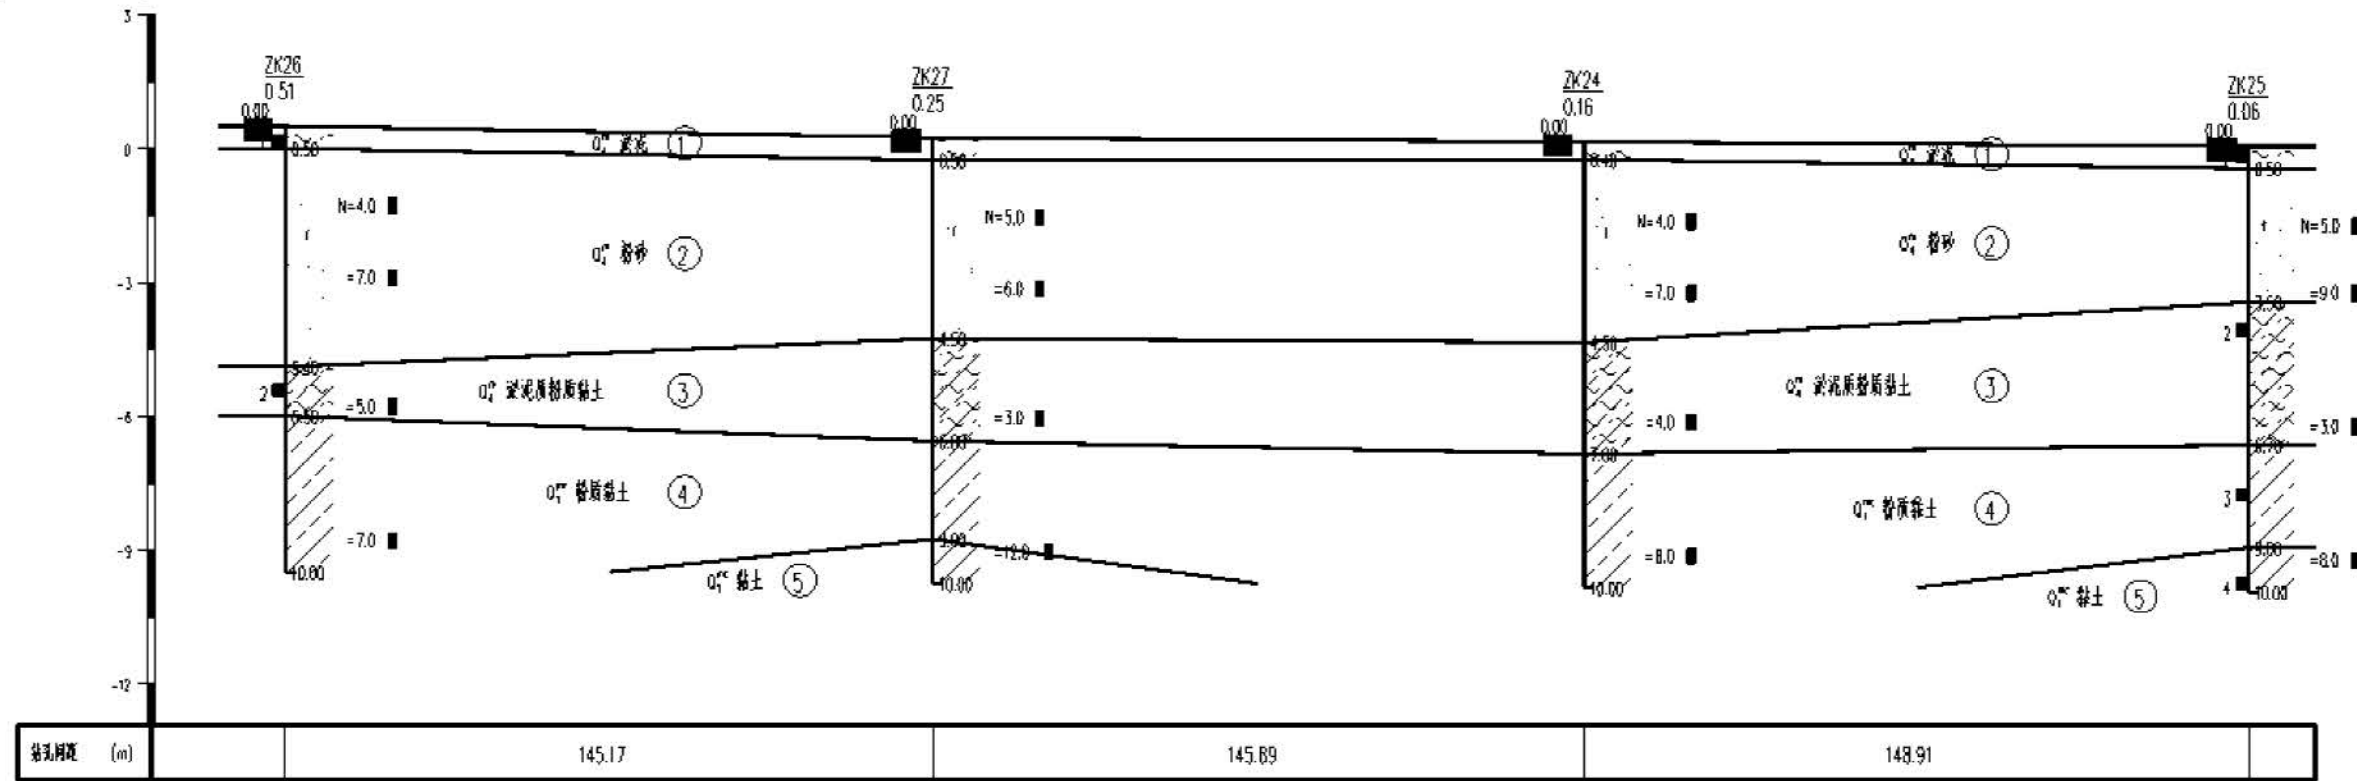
工程高程图 (钻孔平面布置图)
